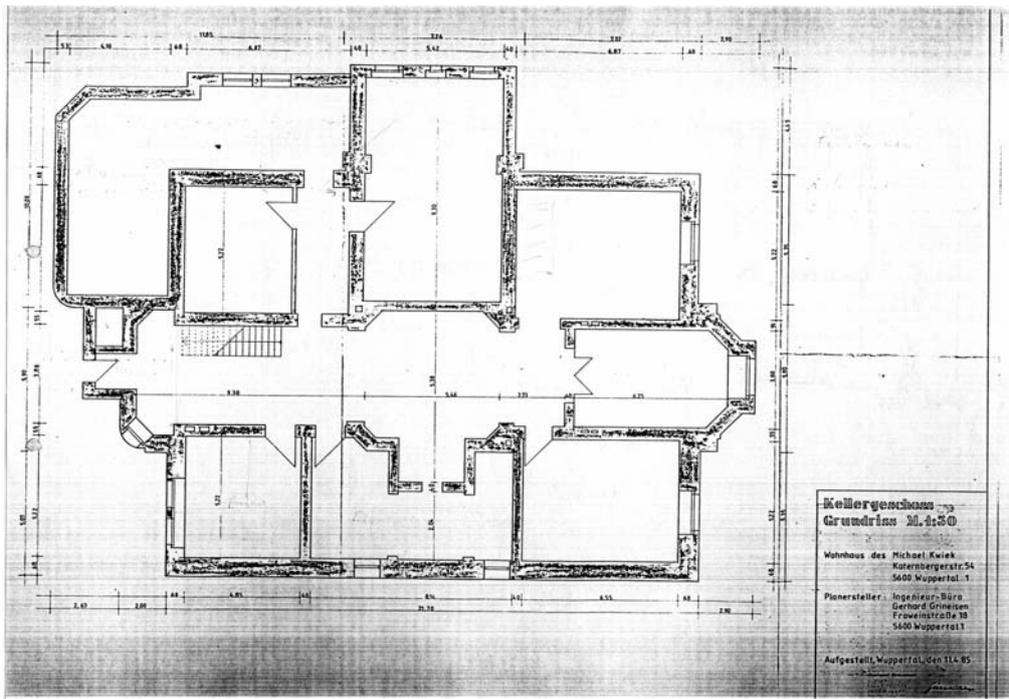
Villa Otto Baum, Grundriss Kellergeschoss, angefertigt vom Ingenieur-Büro Grineisen, Wuppertal, 1985
